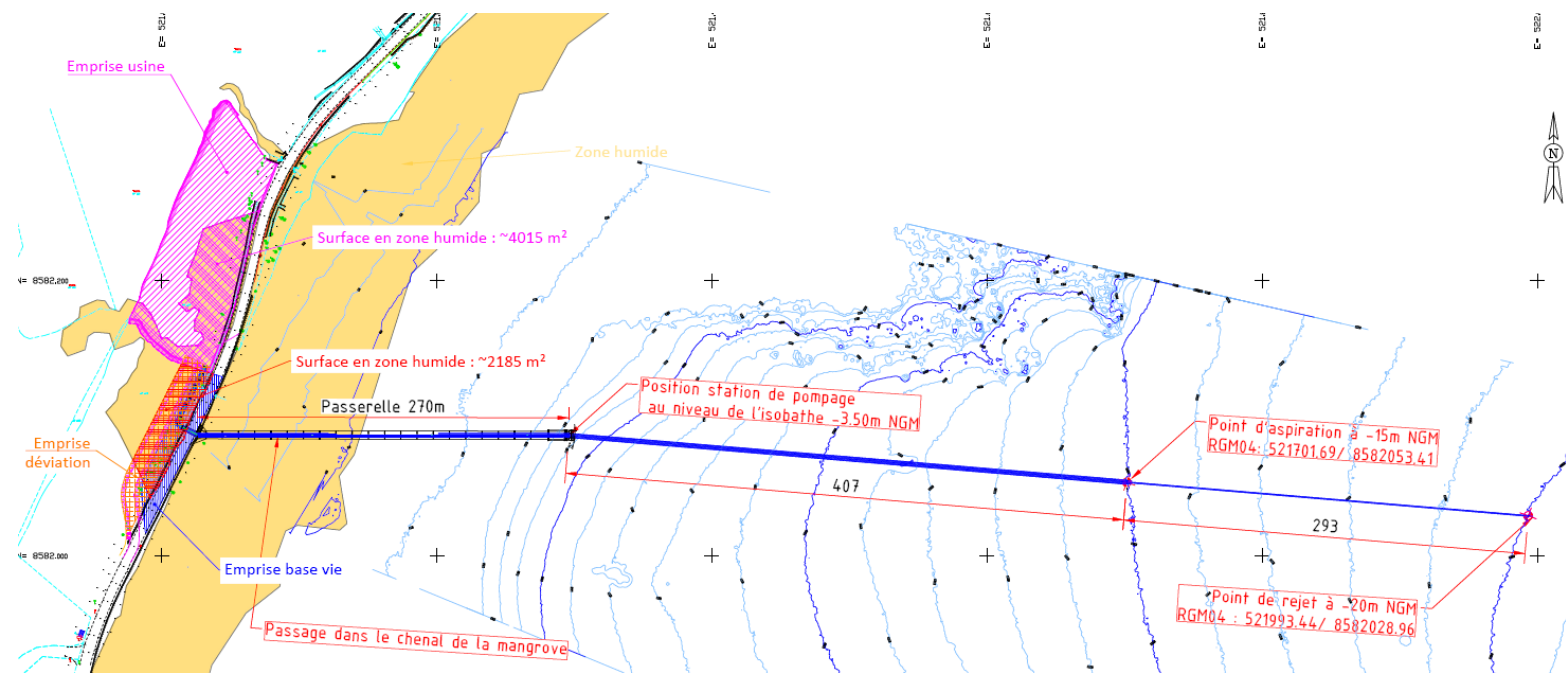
Plan des installations de chantier (version de novembre 2024) – 1/2
